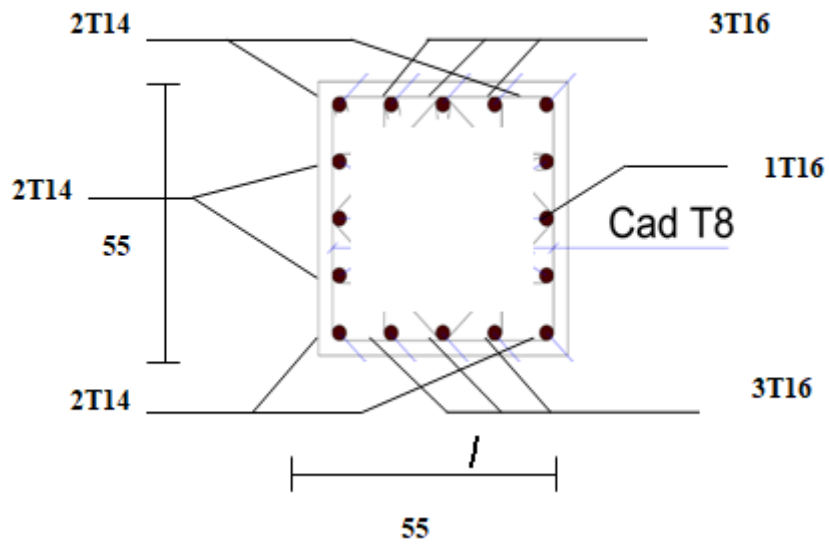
Ferrailage des poteaux (55x55) cm²
